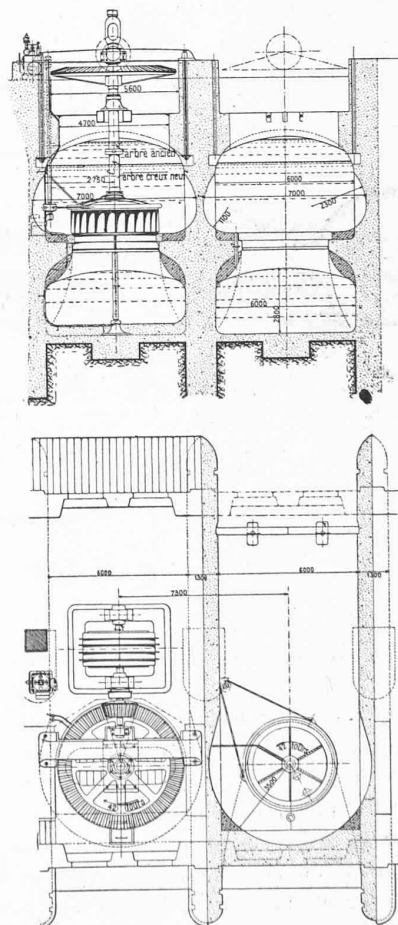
Plan d'installation de deux turbines Usine de Wynau. — Coupe transversale et plan.
